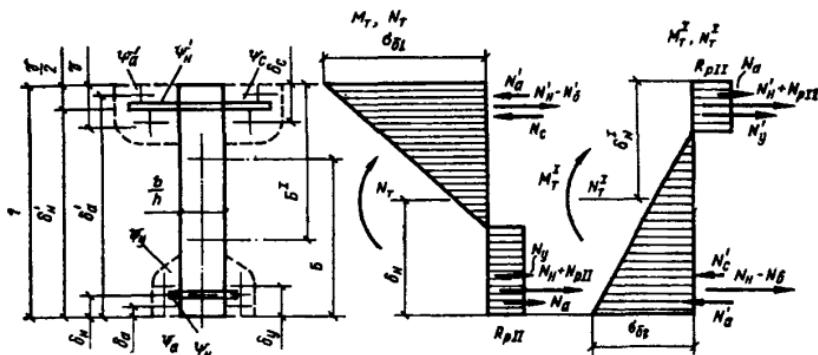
Относительные характеристики и напряженное состояние сечения конструкции в стадии трещинообразования при действии усилий M_t и N_t от эксплуатационной нагрузки и M_t^I и N_t^I — от эксплуатационной нагрузки другого знака или от монтажной нагрузки
